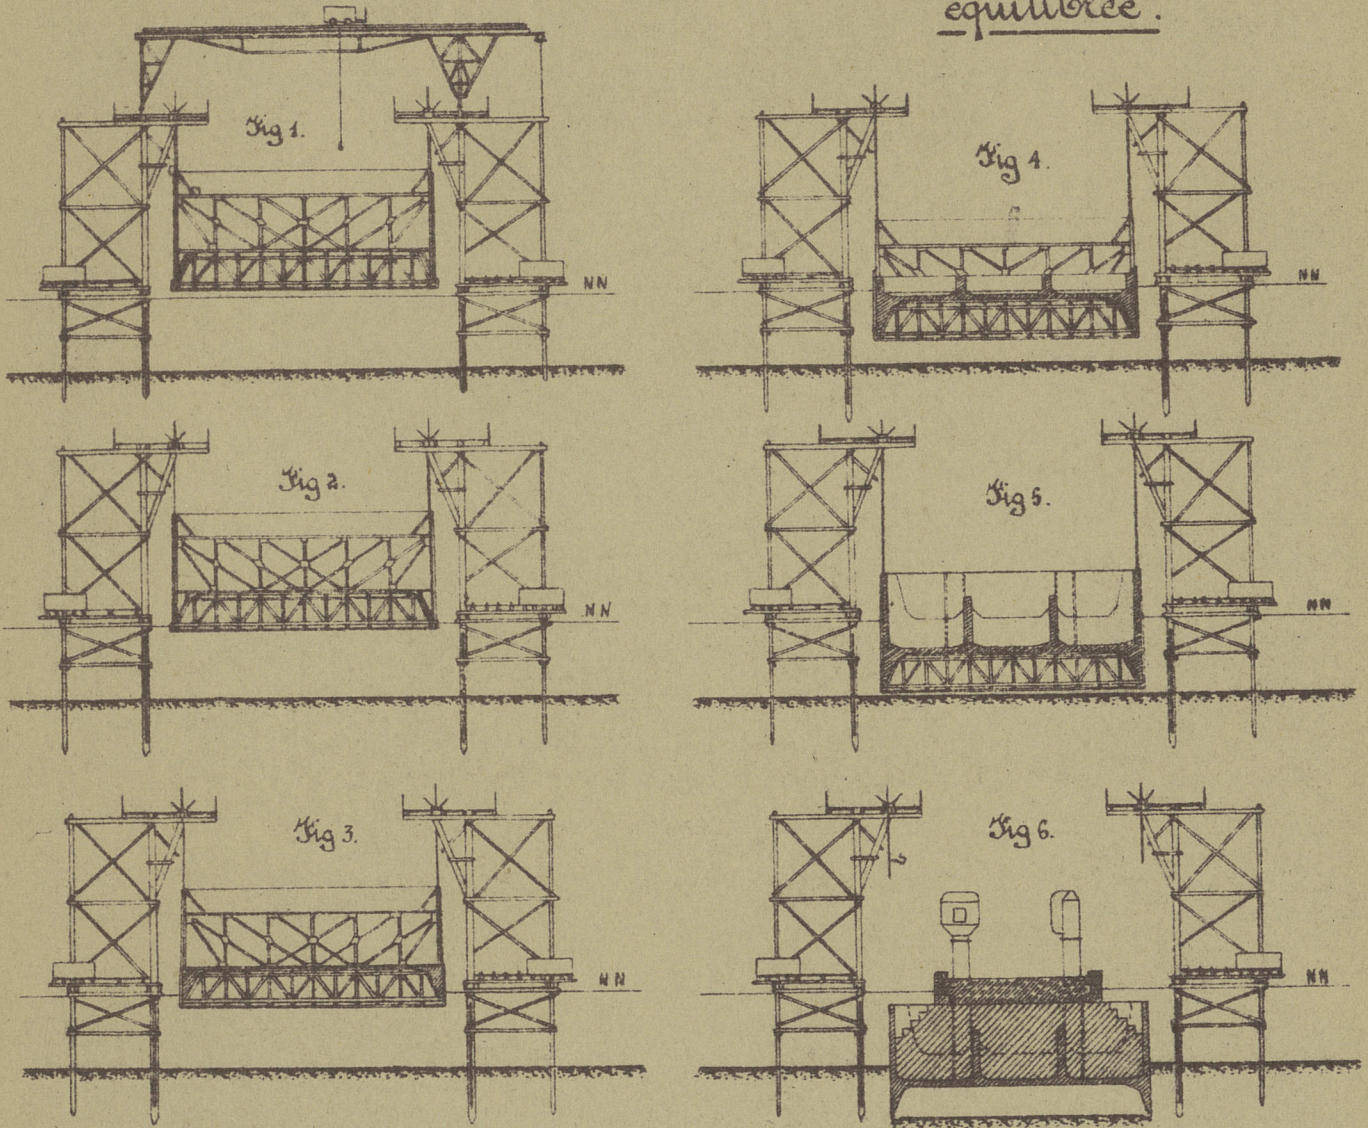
Montage d'un caisson sur échafaudage fixe.
